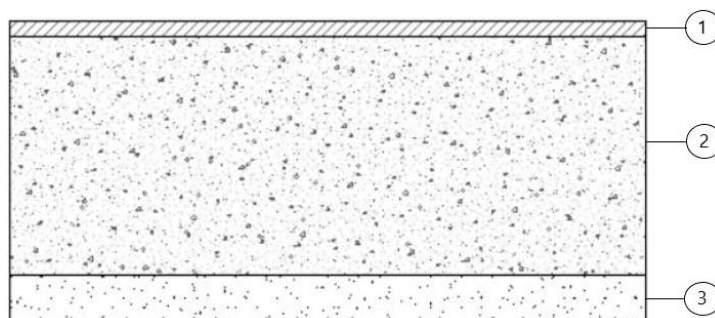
Pormenor da constituição da cobertura – salas de aula e circulação
